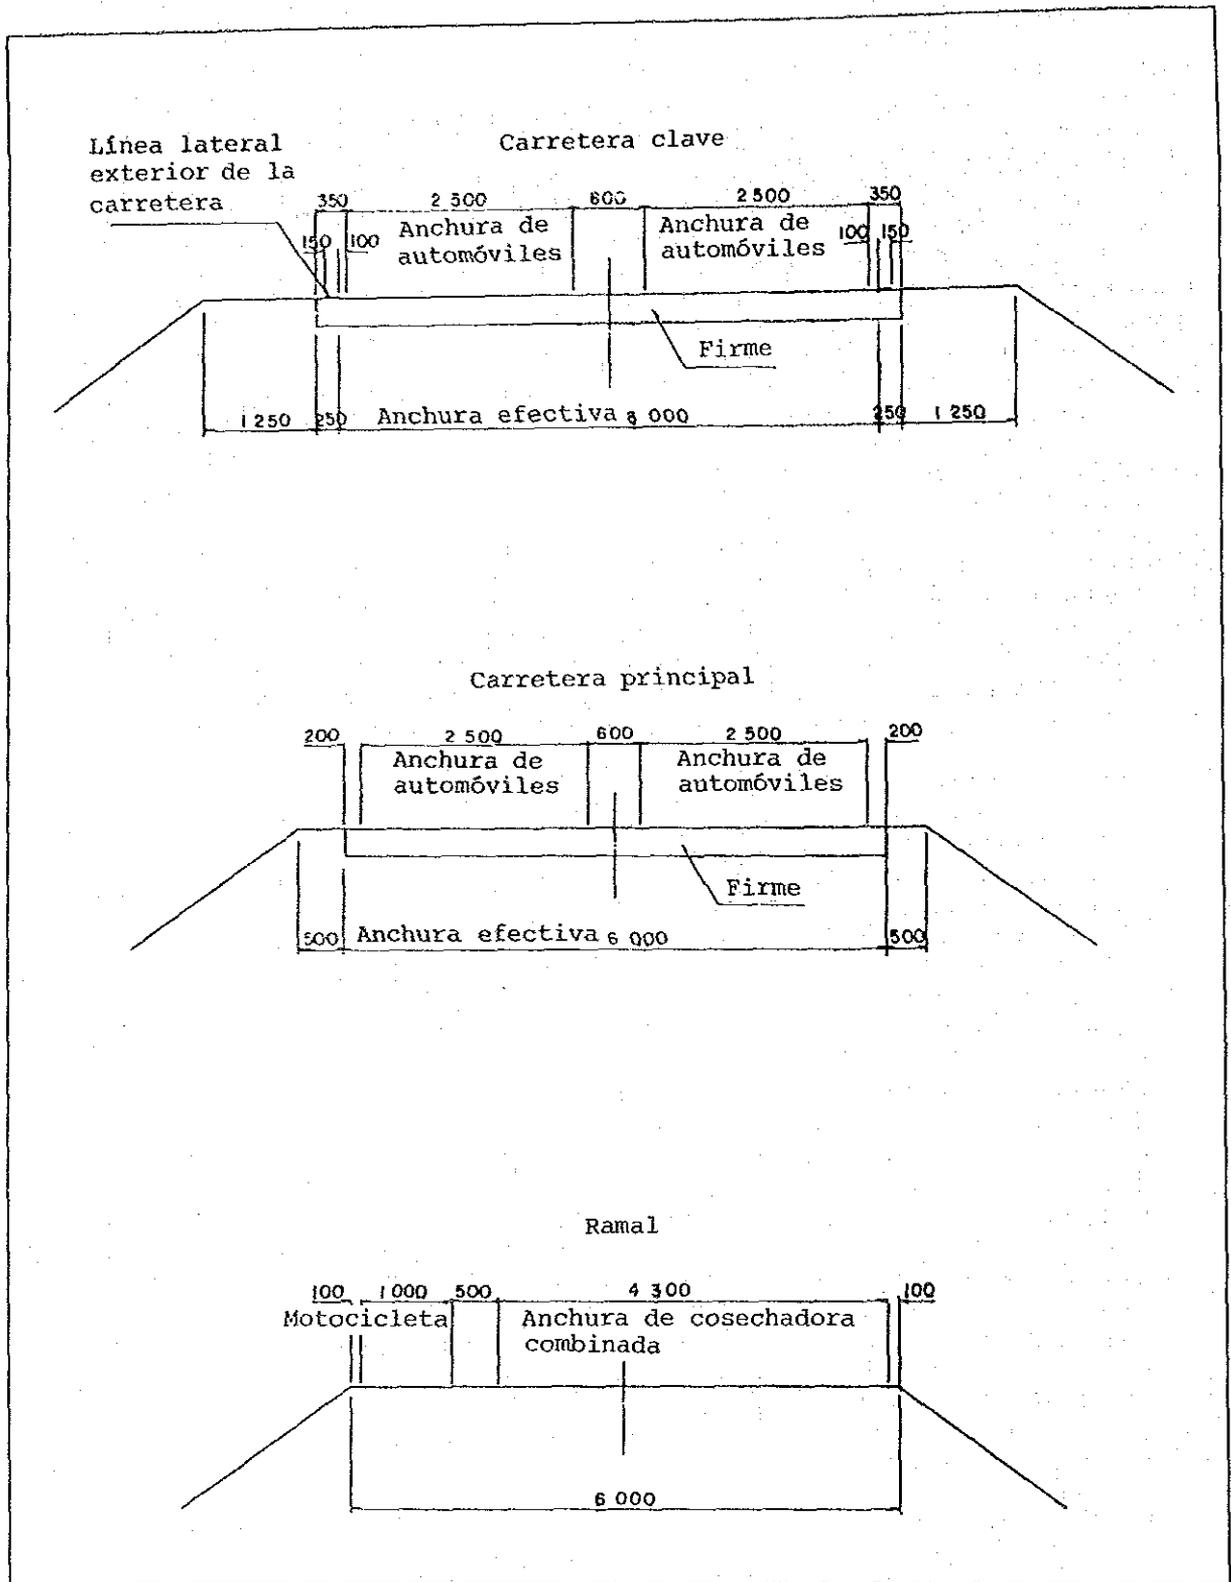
ESTRUCTURA DE PERFIL
